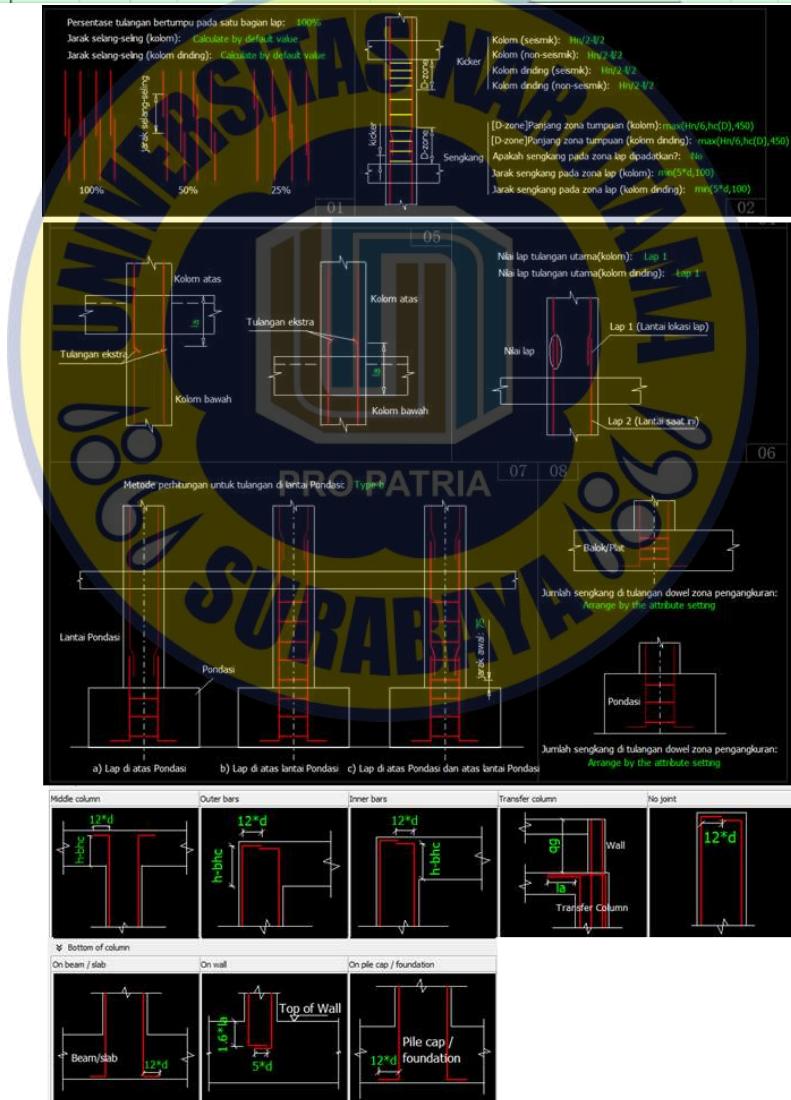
Penulangan Kolom Berdasarkan Detail Perencana. (a) Sambungan Lewatan Tulangan Kolom (b) Detail Penulangan Sengkang pada Kolom
